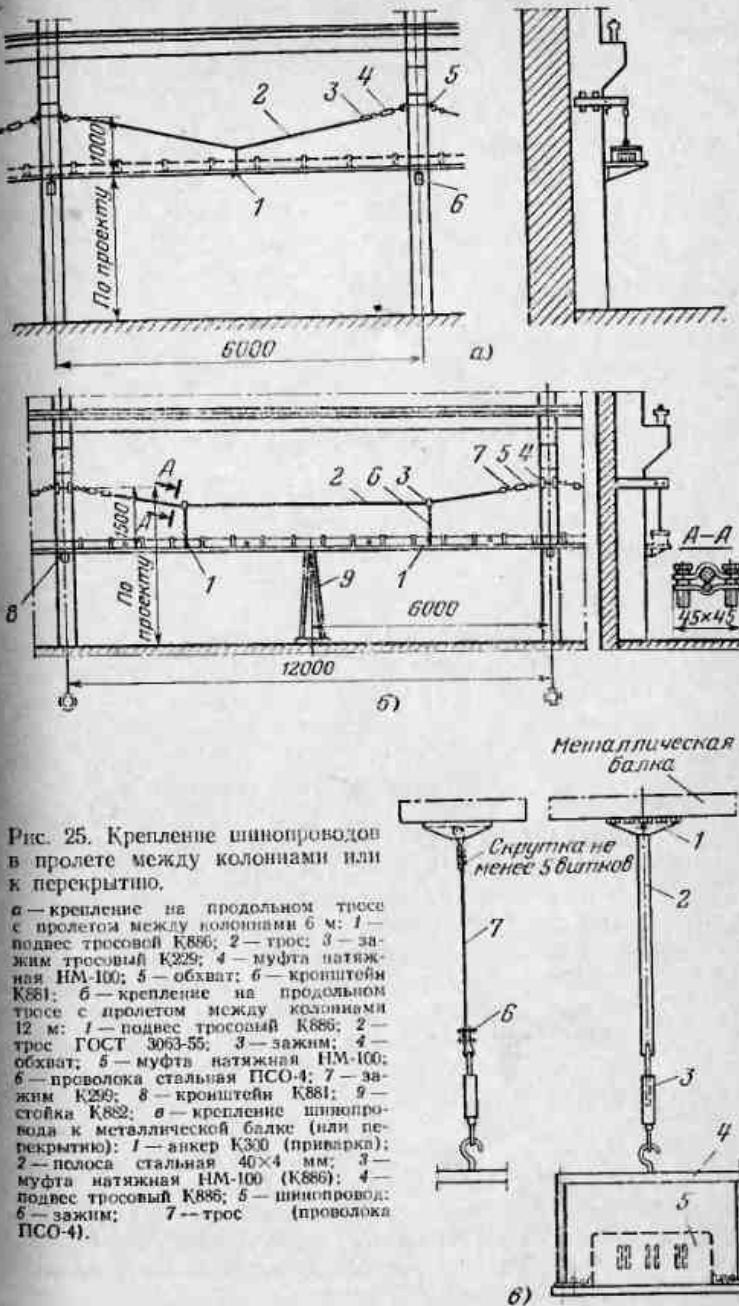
Крепление шинопроводов в пролете между колоннами или перекрытию.
